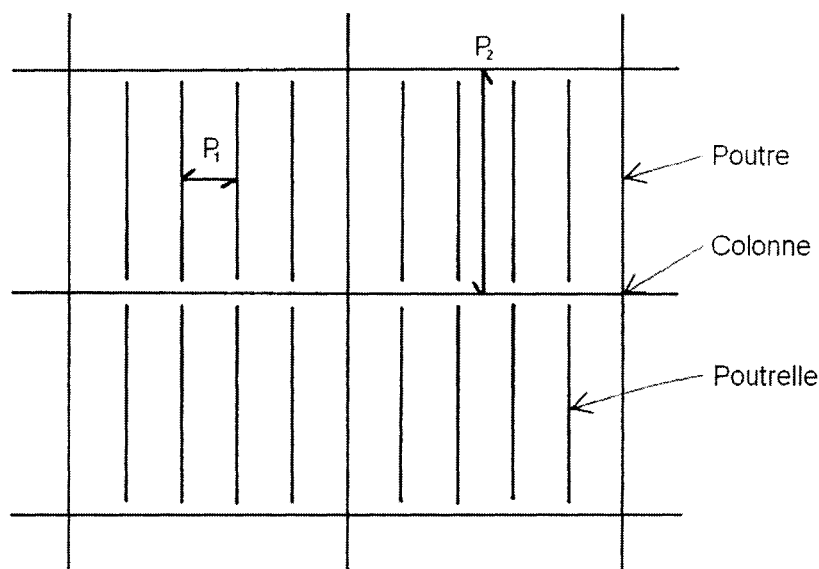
Portée entre poutrelles (P_1) et portée des dalles (P_2)
